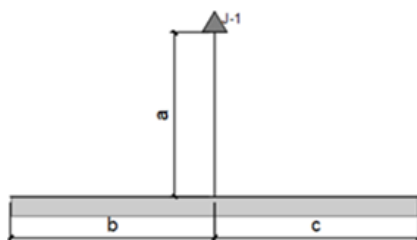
Exemplo de jazida e pontos de aplicação – 1º Caso
